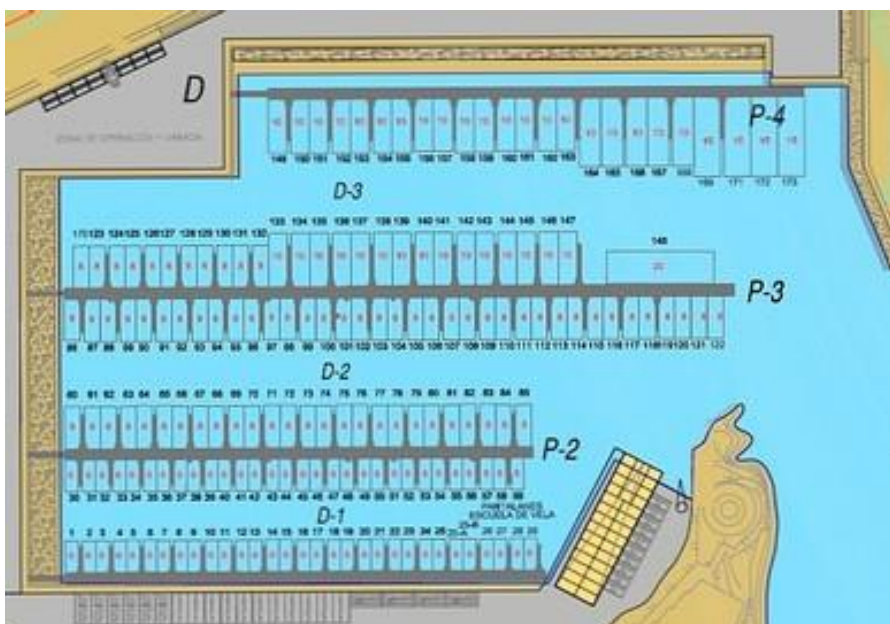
Plano Puerto deportivo La Galera (Tenerife). Fuente : surcando.com
